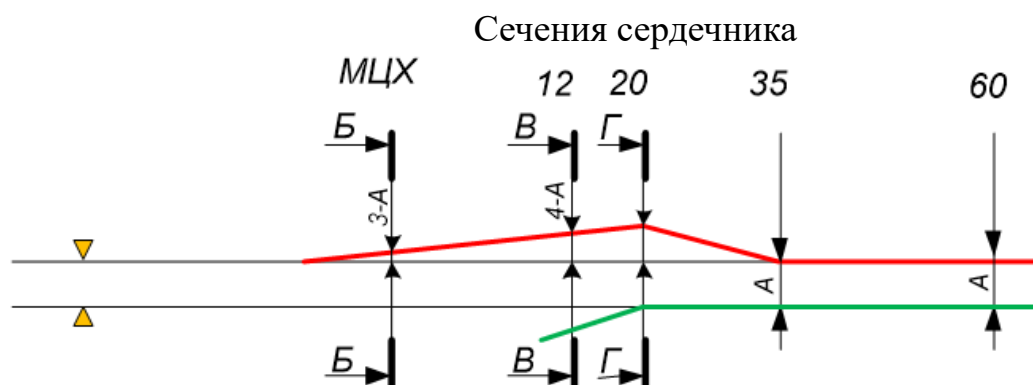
Продольный профиль наплавленных острых сборных крестовин после обработки: А – величина равномерного износа в сечении сердечника 60 мм; ▼ – база измерения по верху головки рельсовых усовиков; ▲ – уровень равномерного износа
